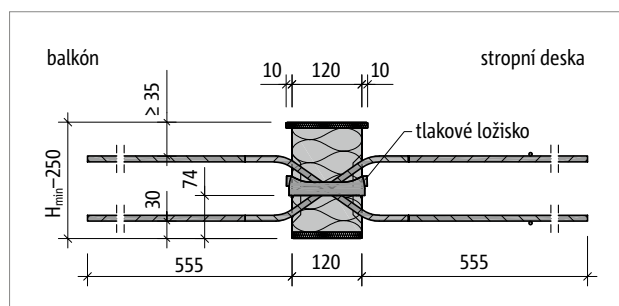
Schöck Isokorb® XT typ QL-V10: Řez prvkem
